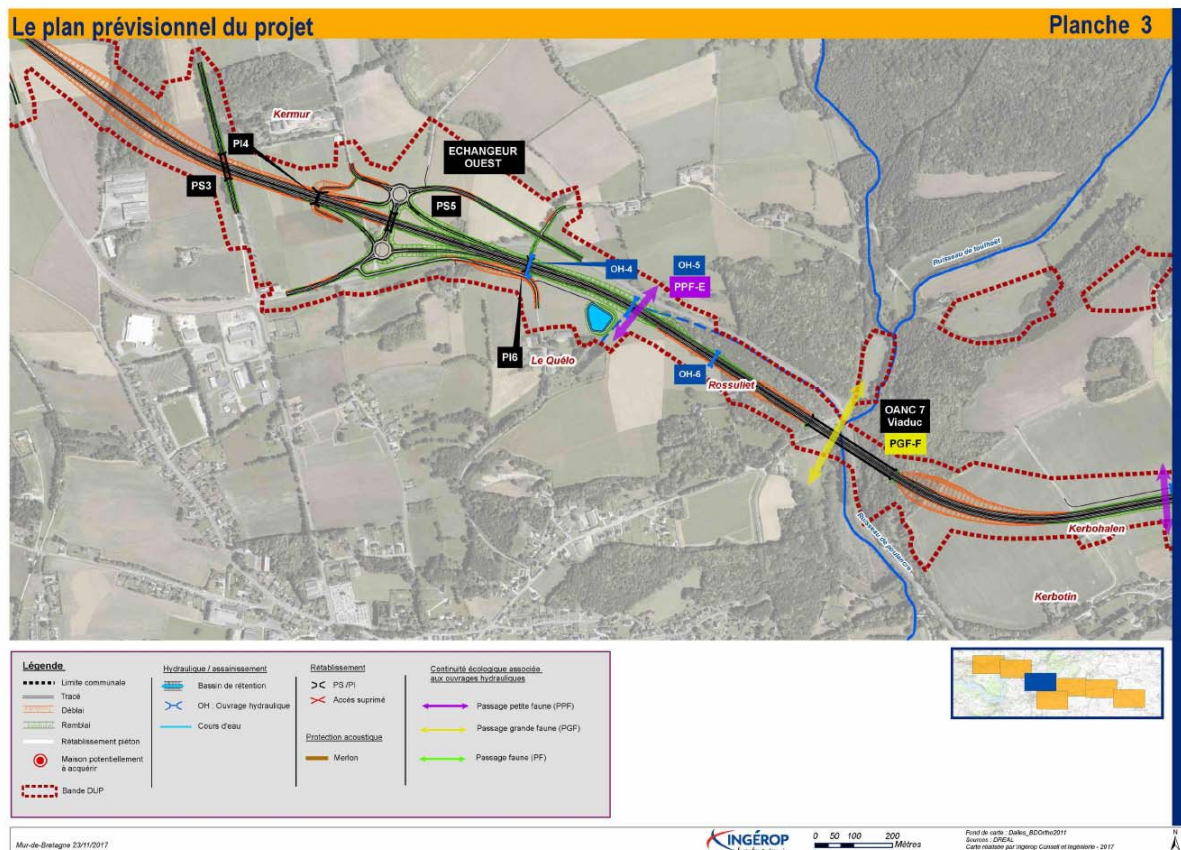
Plan prévisionnel des travaux. Planche 3. Source : dossier
